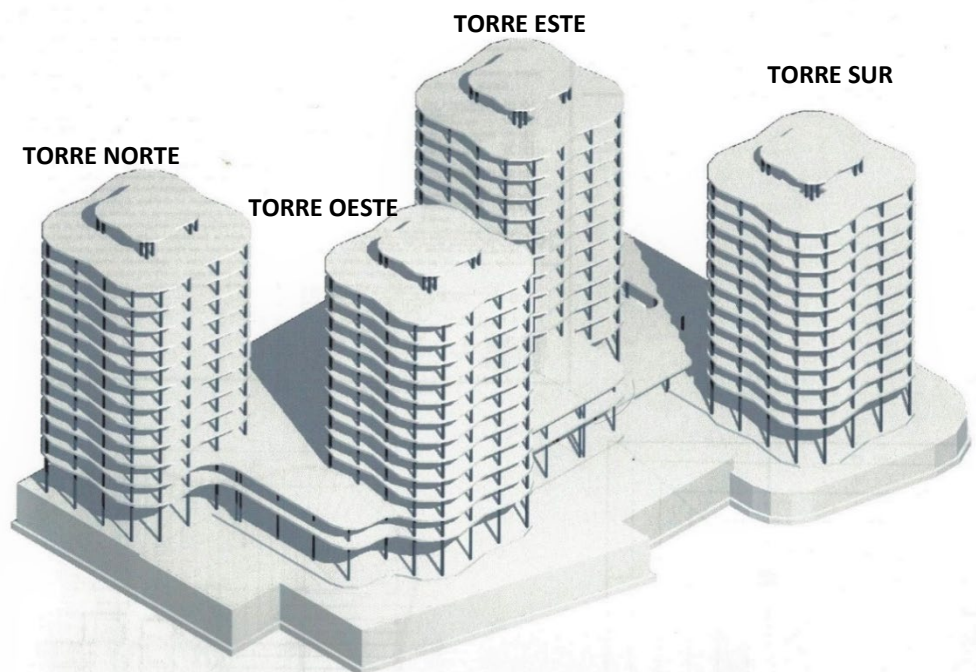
Esquema estructural de las torres. Fuente: (Corbetta y Parés 2005)
